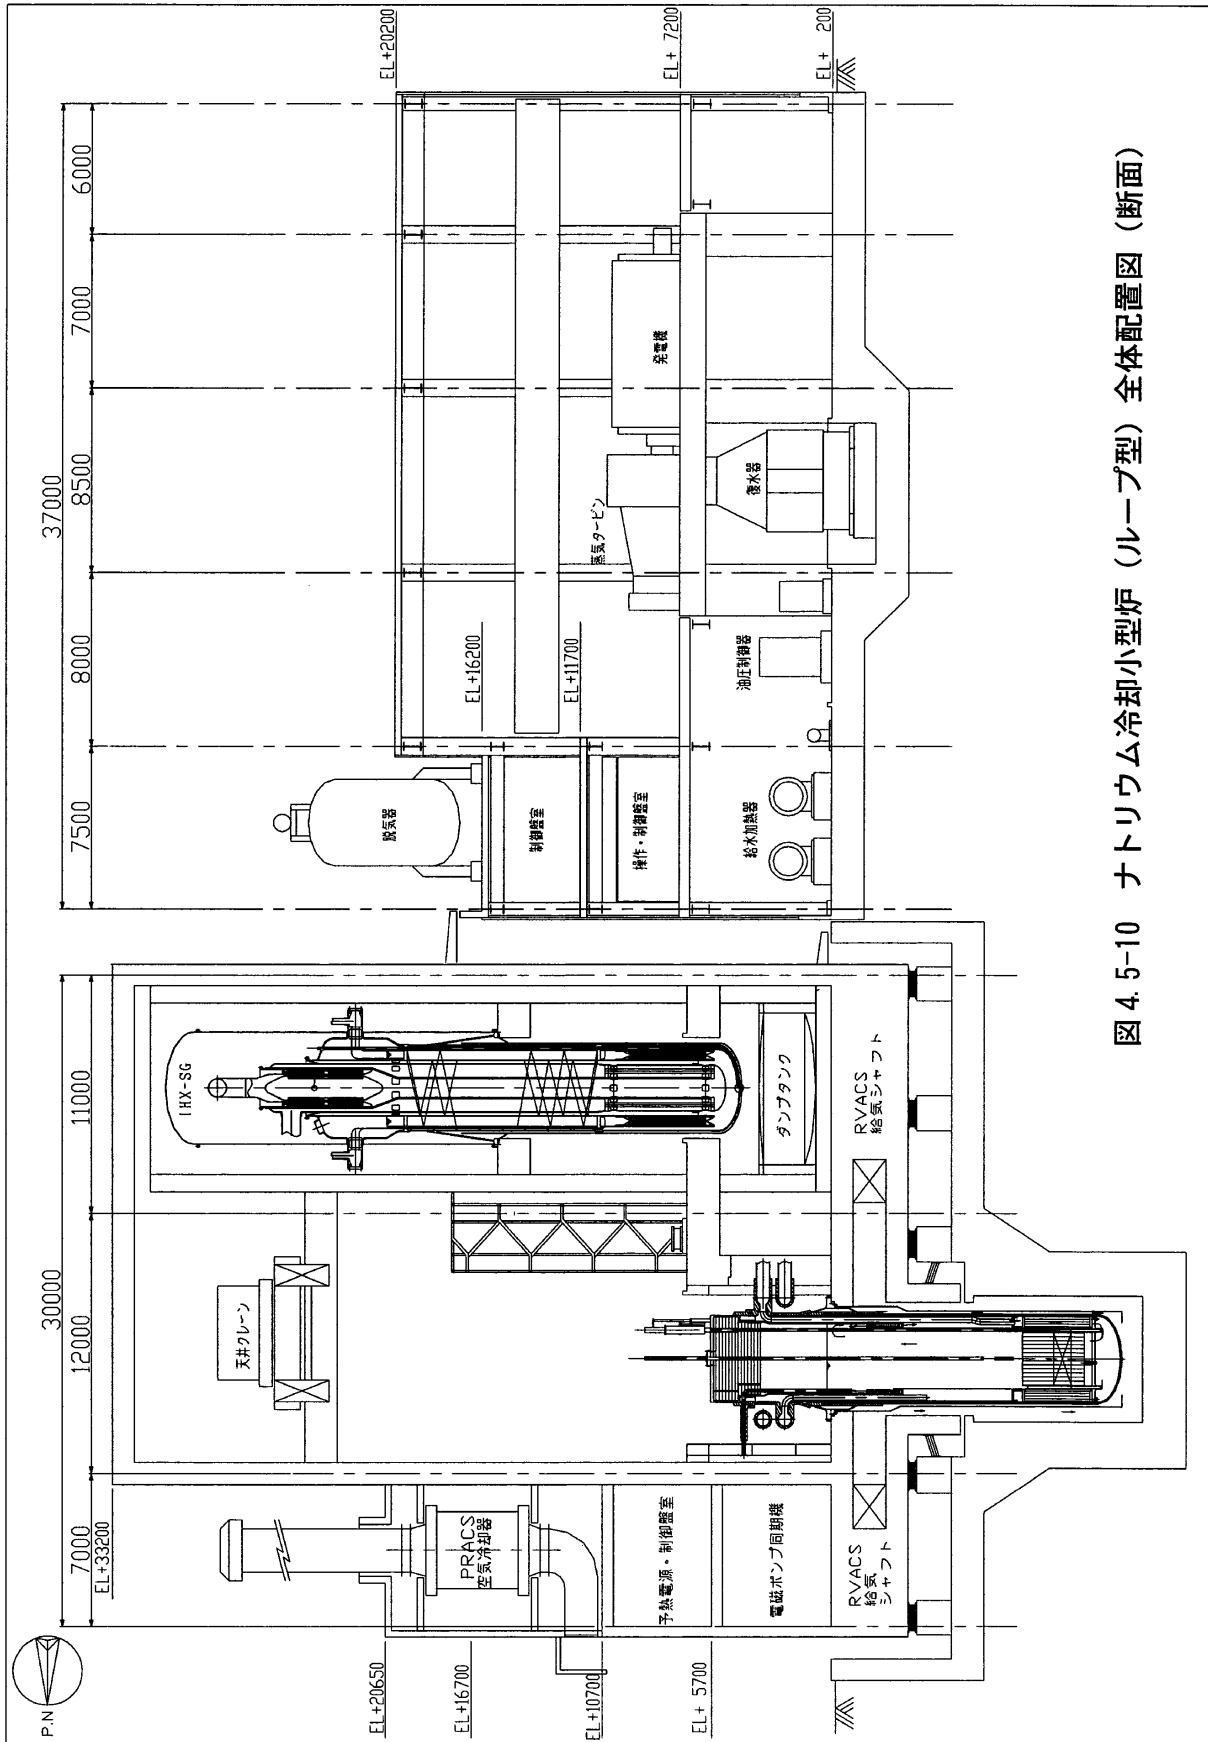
ナトリウム冷却小型炉 (ループ型) 全体配置図 (断面)
